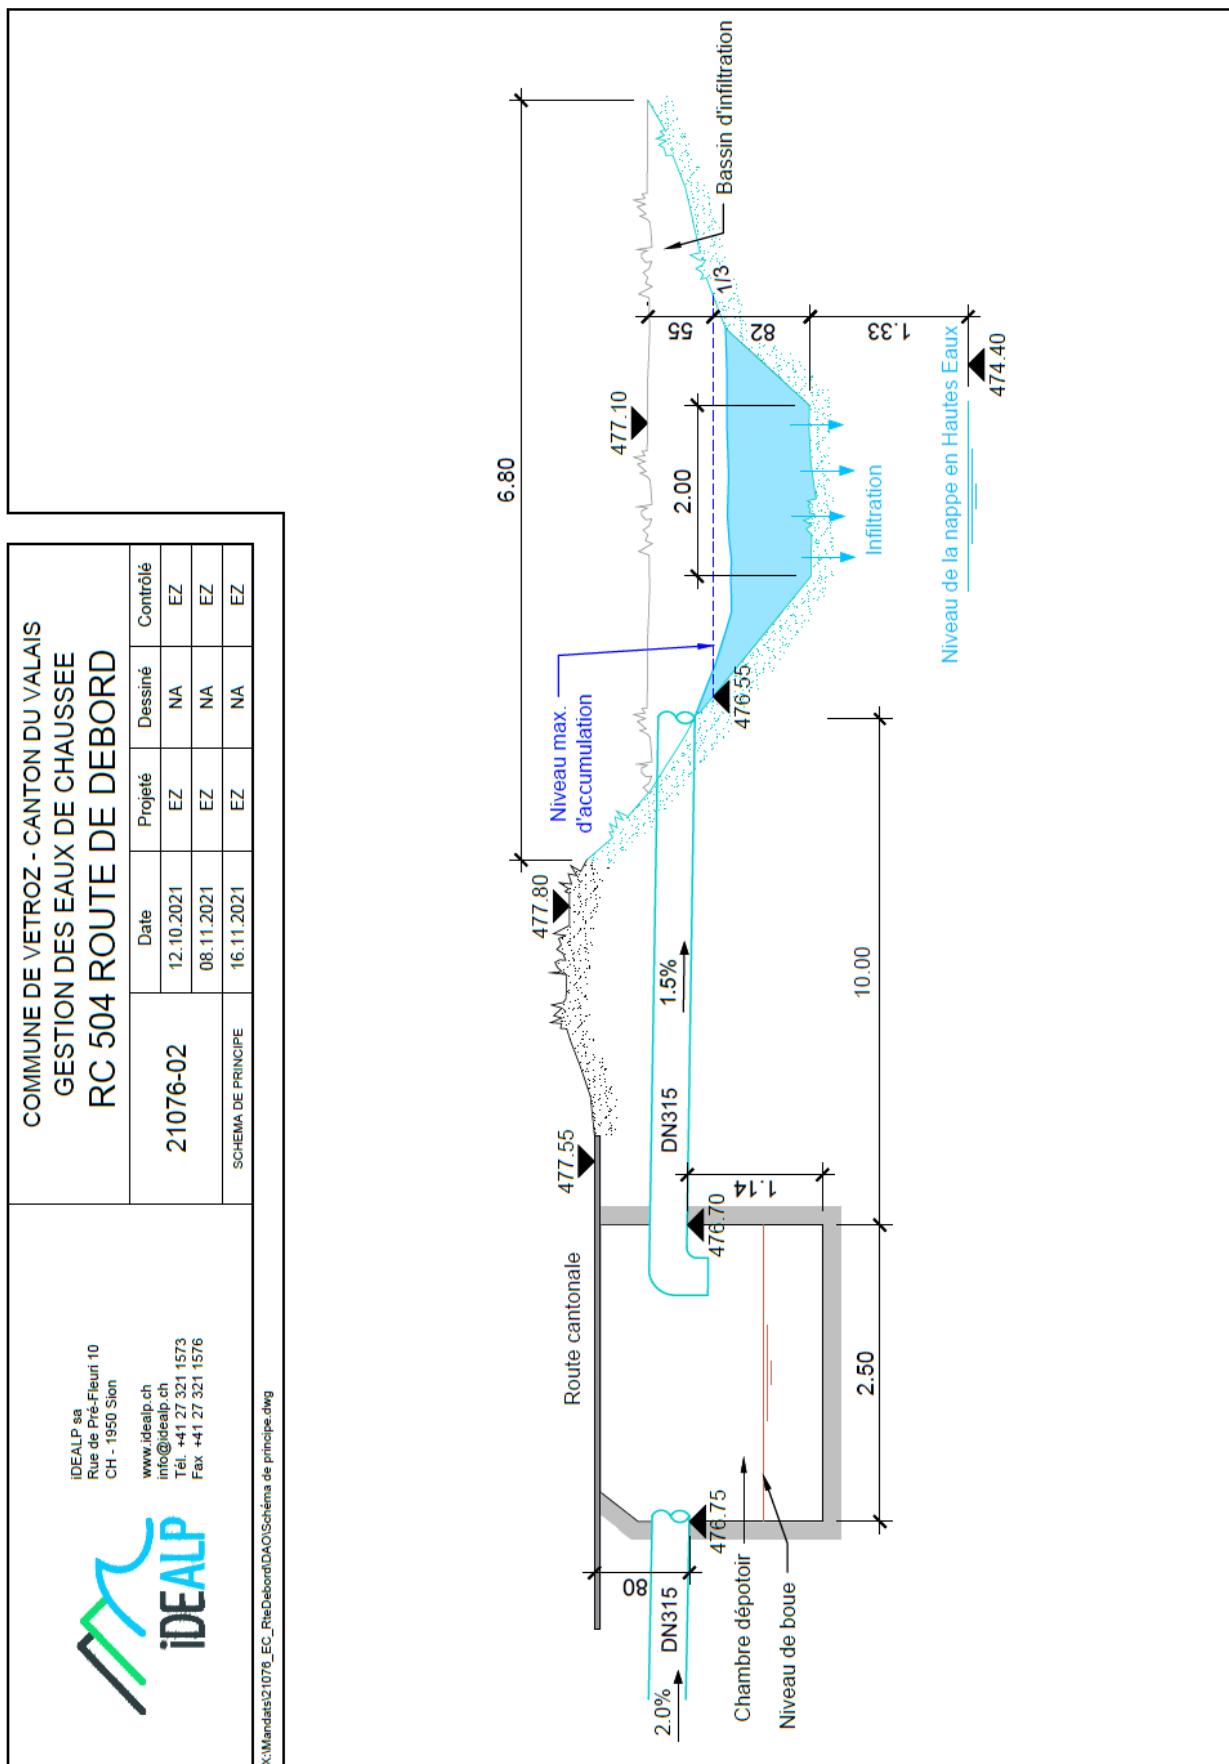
Schéma de principe pour le déversement des eaux de chaussée au bassin d'infiltration
